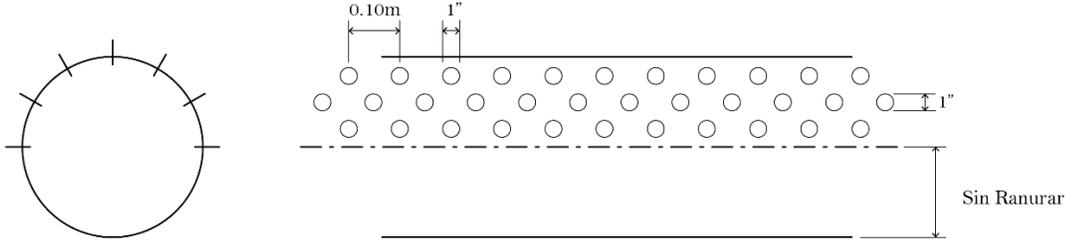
Diagrama de detalle de ranurado de tubo (media caña) para drenes trapezoidales de captación de lixiviado
